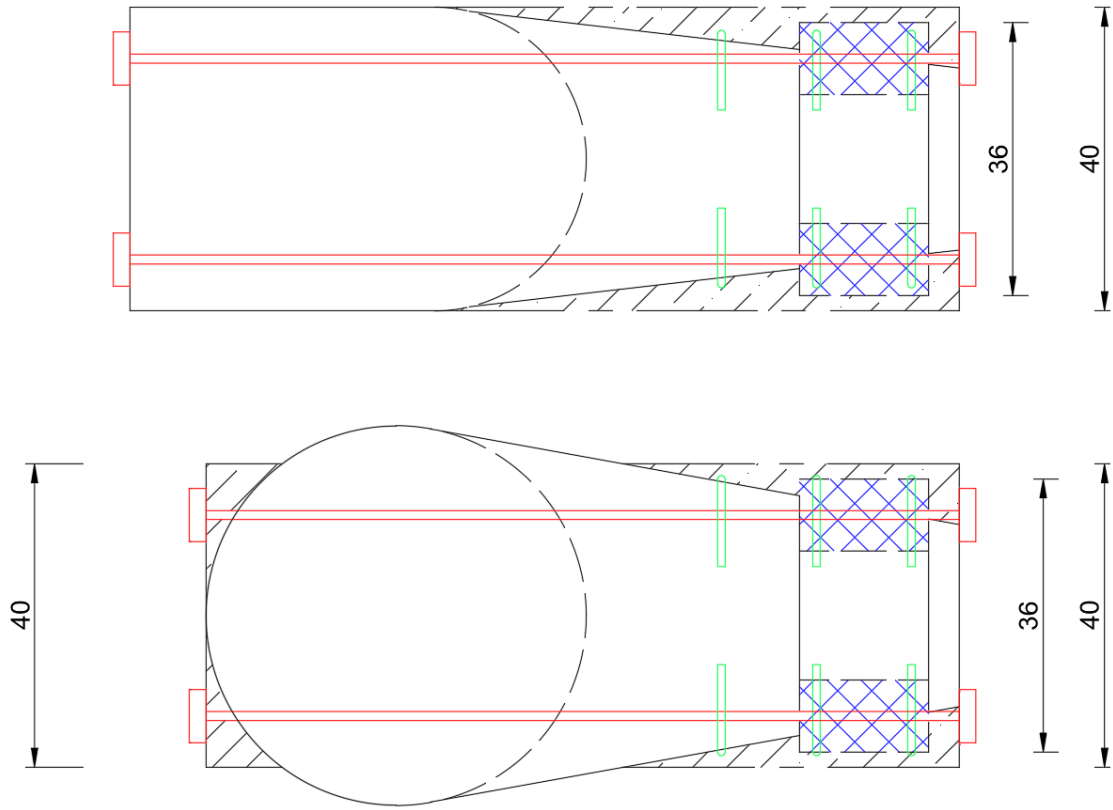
Vista en planta del reforzo. Ménsulas en ejes 14-18.
